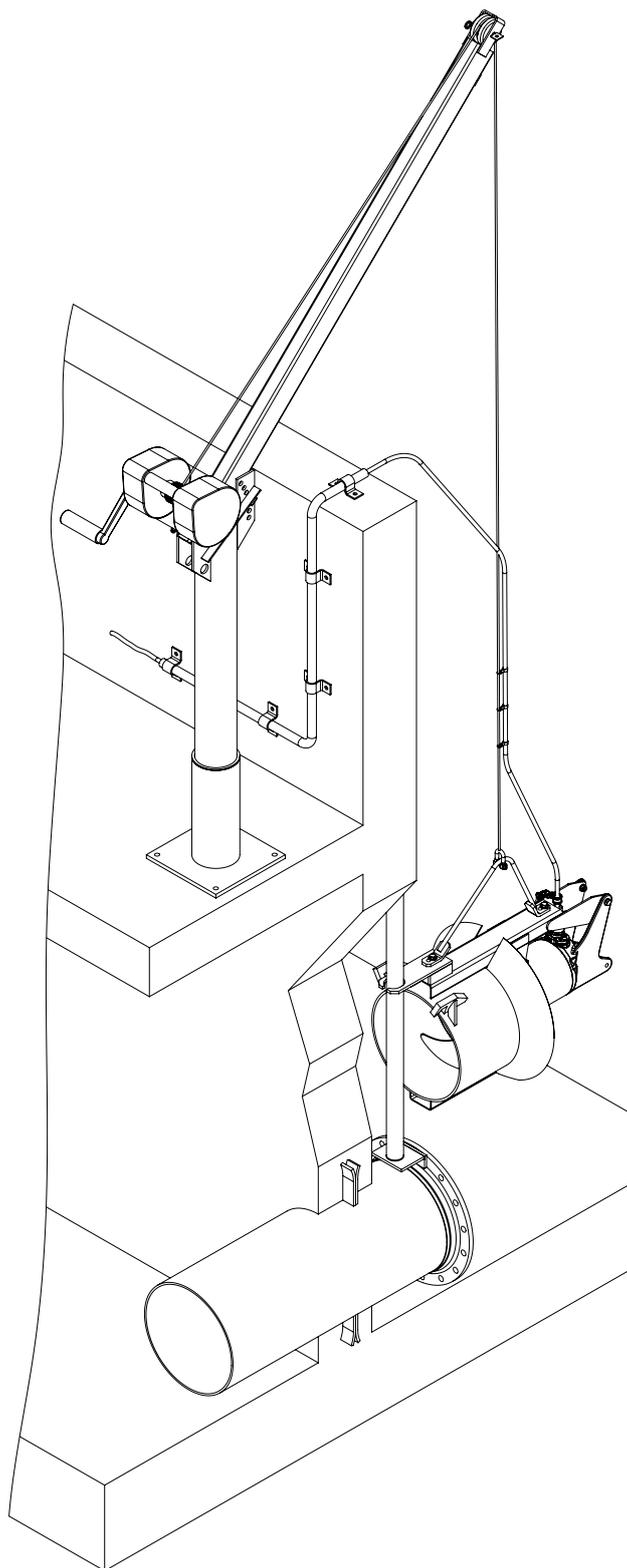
Exemplo de instalação com aparelho de elevação ABS 5 kN
